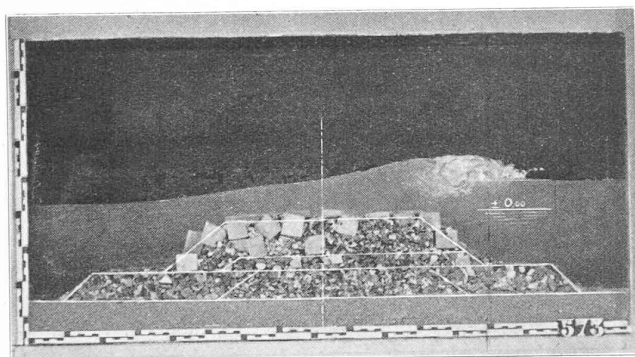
Dimensions de la vague  $2h = 6,00$  m.  $2L = 120$  m. Vue prise à l'instant du déferlement complet de la vague.
